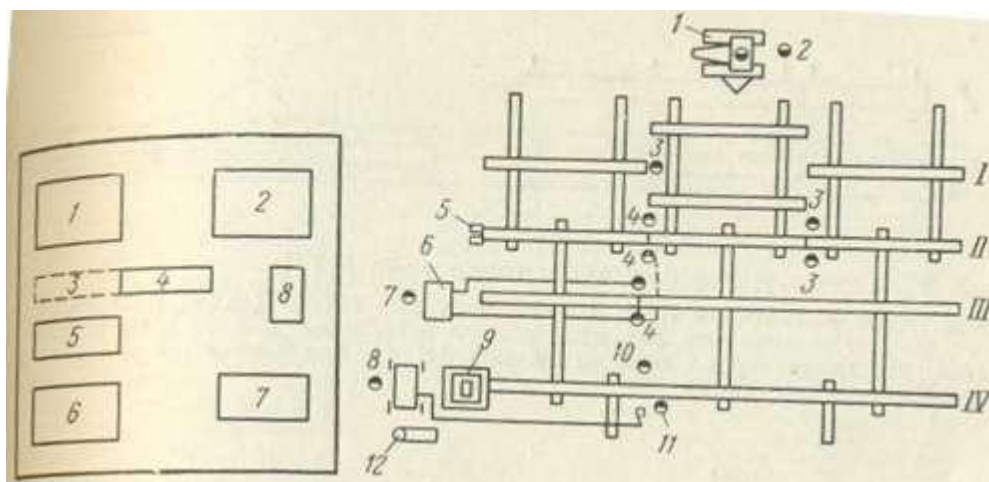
Типовой генеральный план сварочной базы. Схема размещения оборудования и рабочих постов на полевой трубосварочной базе для поворотной сварки стыков [4]:
